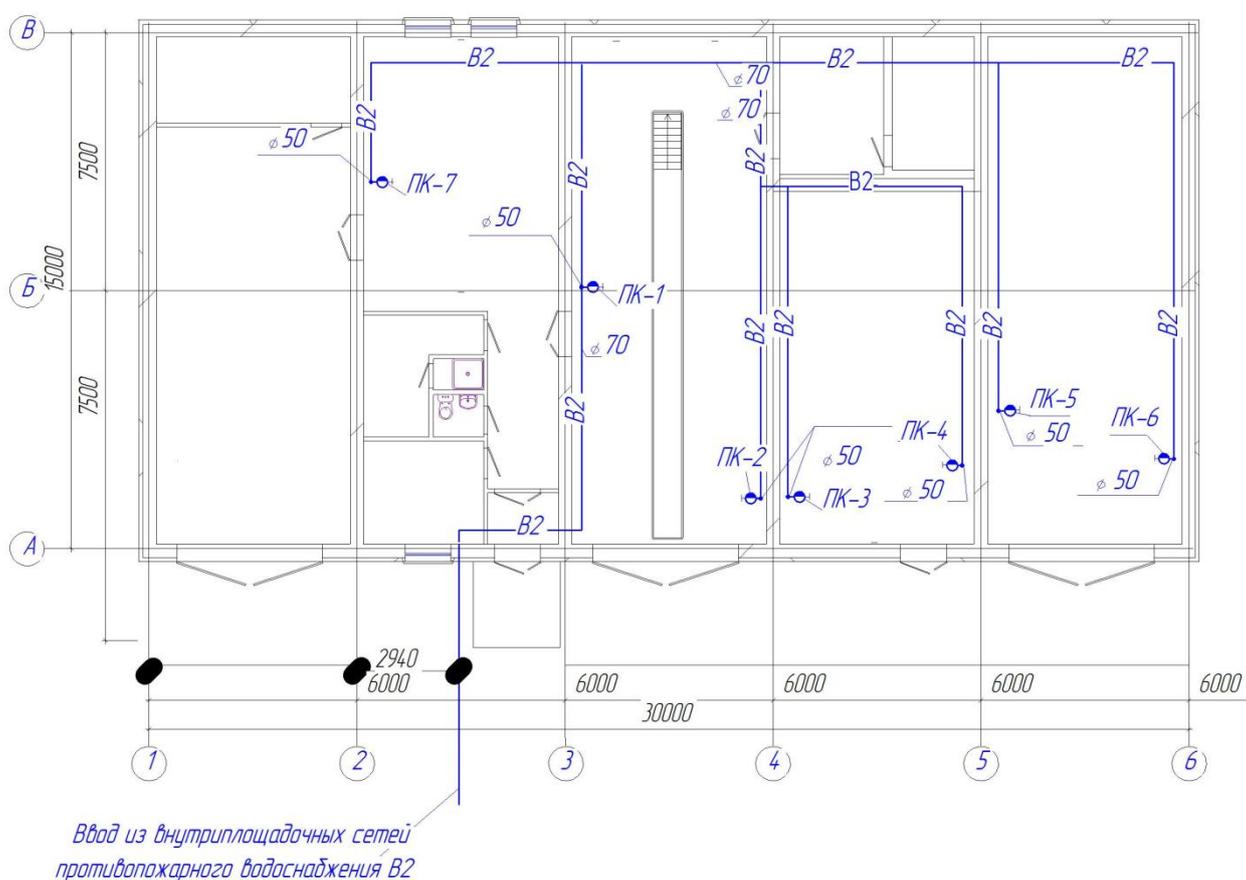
Схема размещения пожарных кранов и трубопроводов внутреннего противопожарного водоснабжения здания гаража
